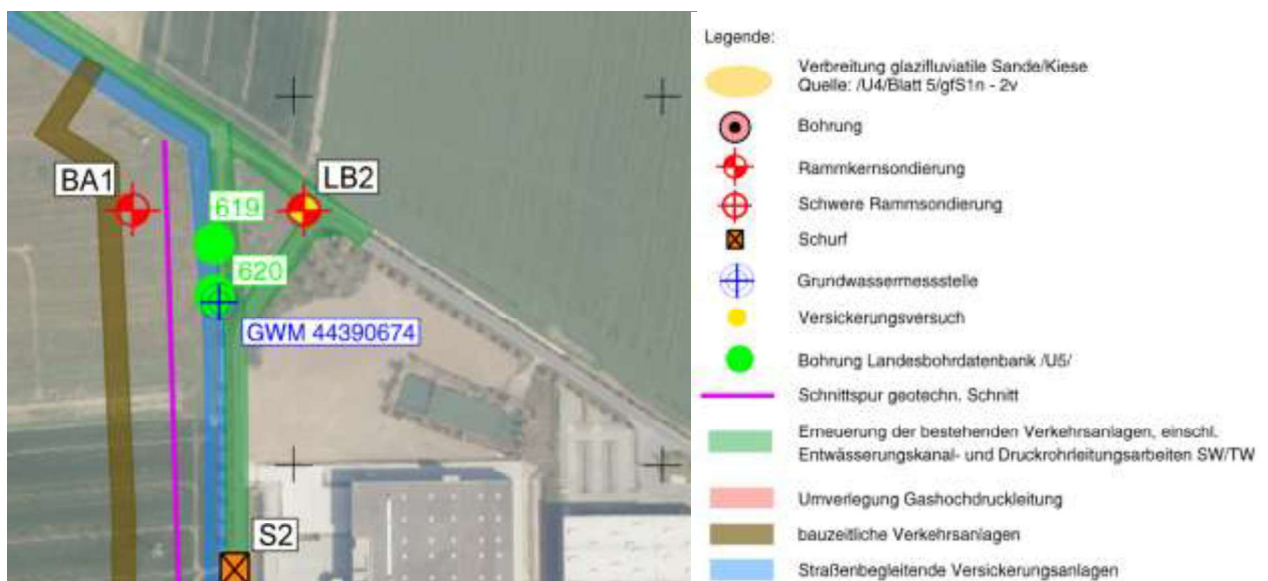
Auszug Baugrundgutachten GI Brehna (Lageplan) [1]
